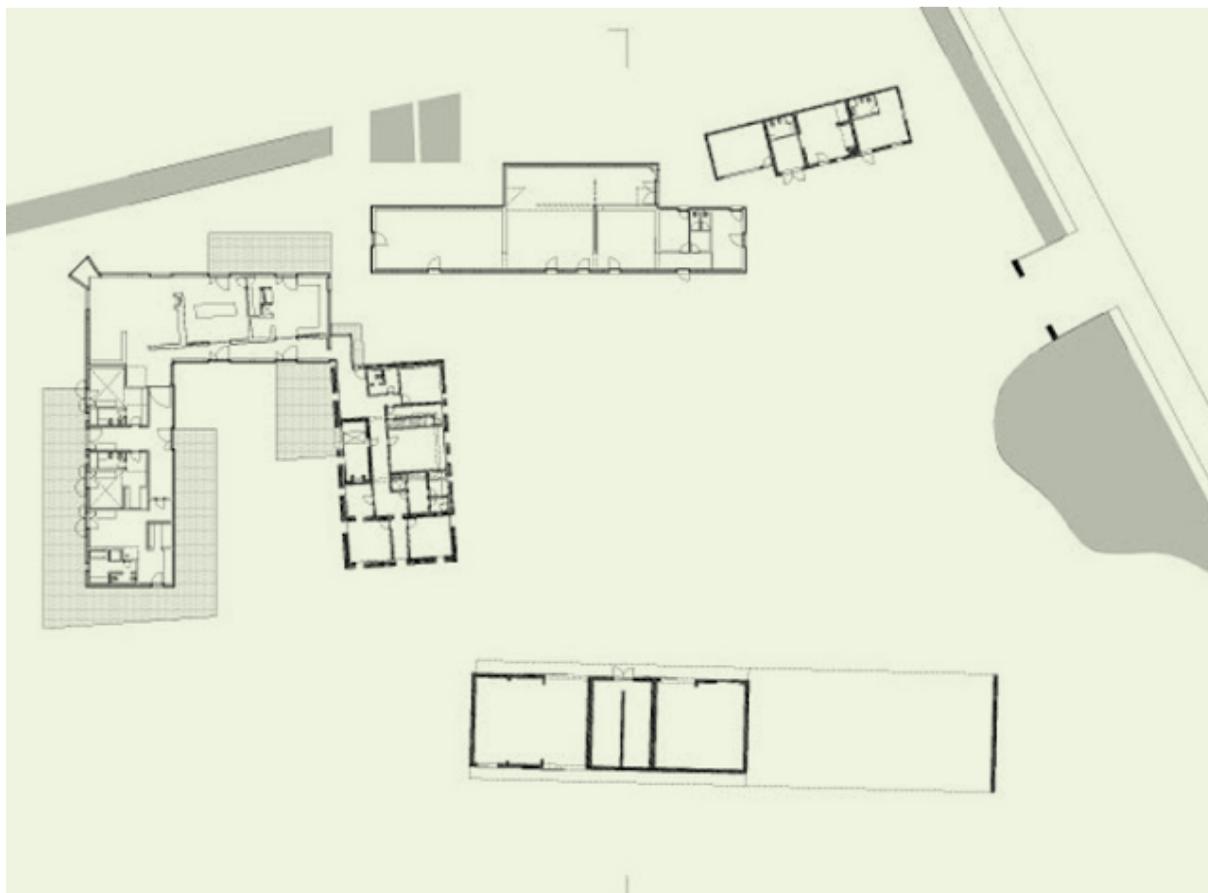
Planta do piso ré-sdo-chão – Casa Van Middelen
